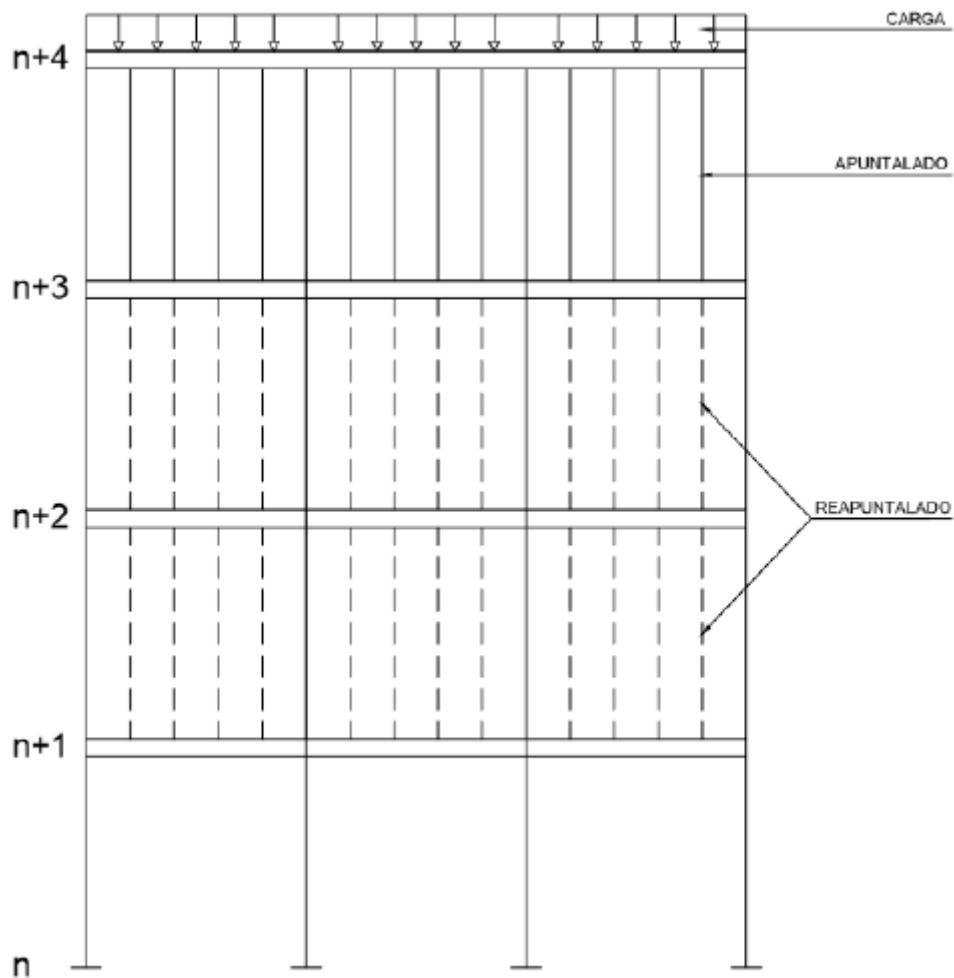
Apuntalamiento construcción de varios pisos, según ACI 347.2R-05, Guide for Shoring/Reshoring of Concrete Multistory Buildings
